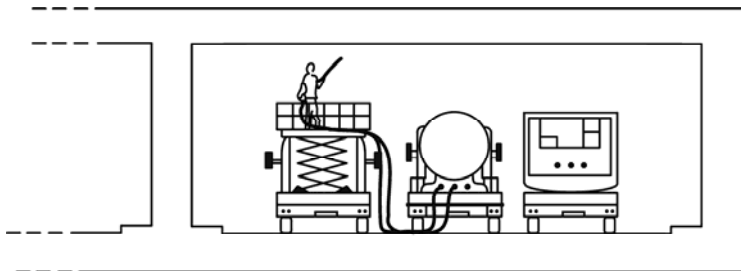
HDWS mittels Handlanzen unter Nutzung des gesamten Querschnittes
